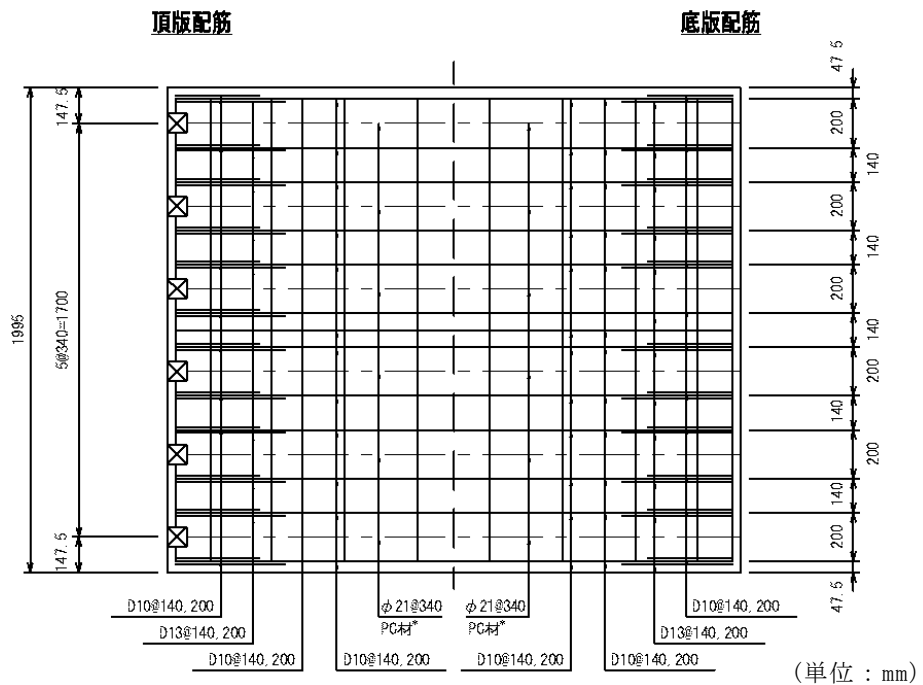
(4) 屋外排水路（防波壁横断部）の概略配筋図（側壁）
